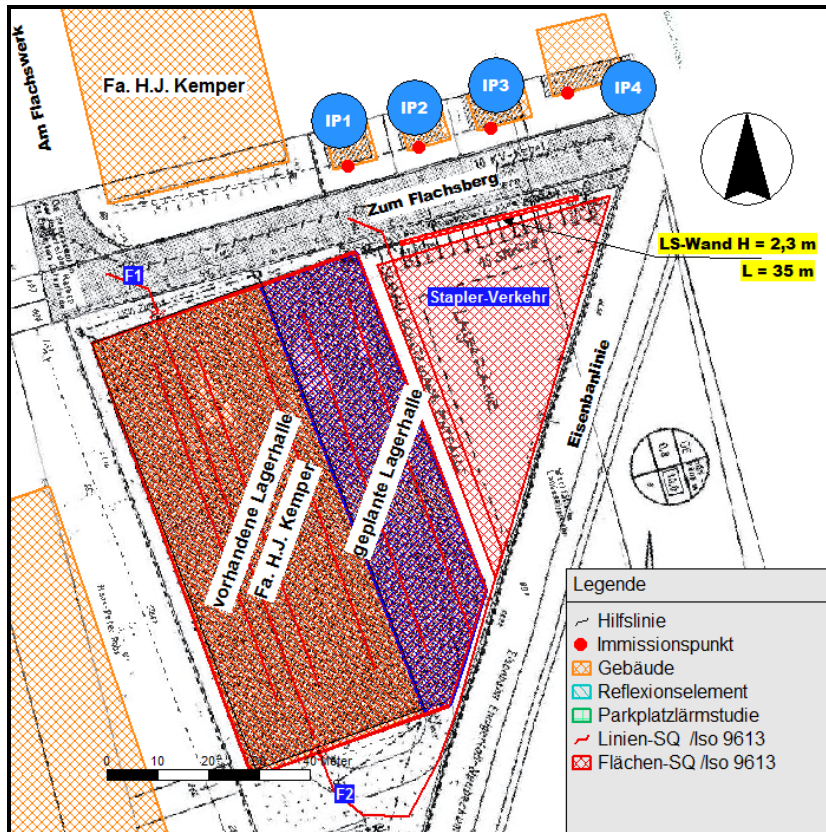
Auszug Lageplan, mit zusätzlichem Schallschutz
